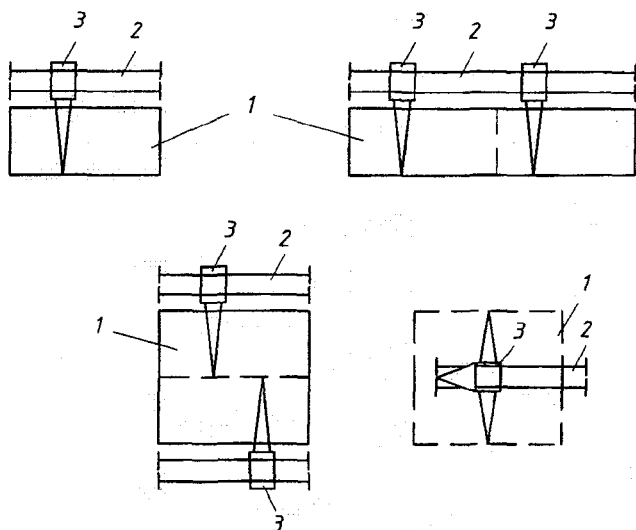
Варианты расположения башенных кранов при монтаже многоэтажных зданий: 1 – монтируемое здание; 2 – подкрановый путь; 3 – башенный кран
